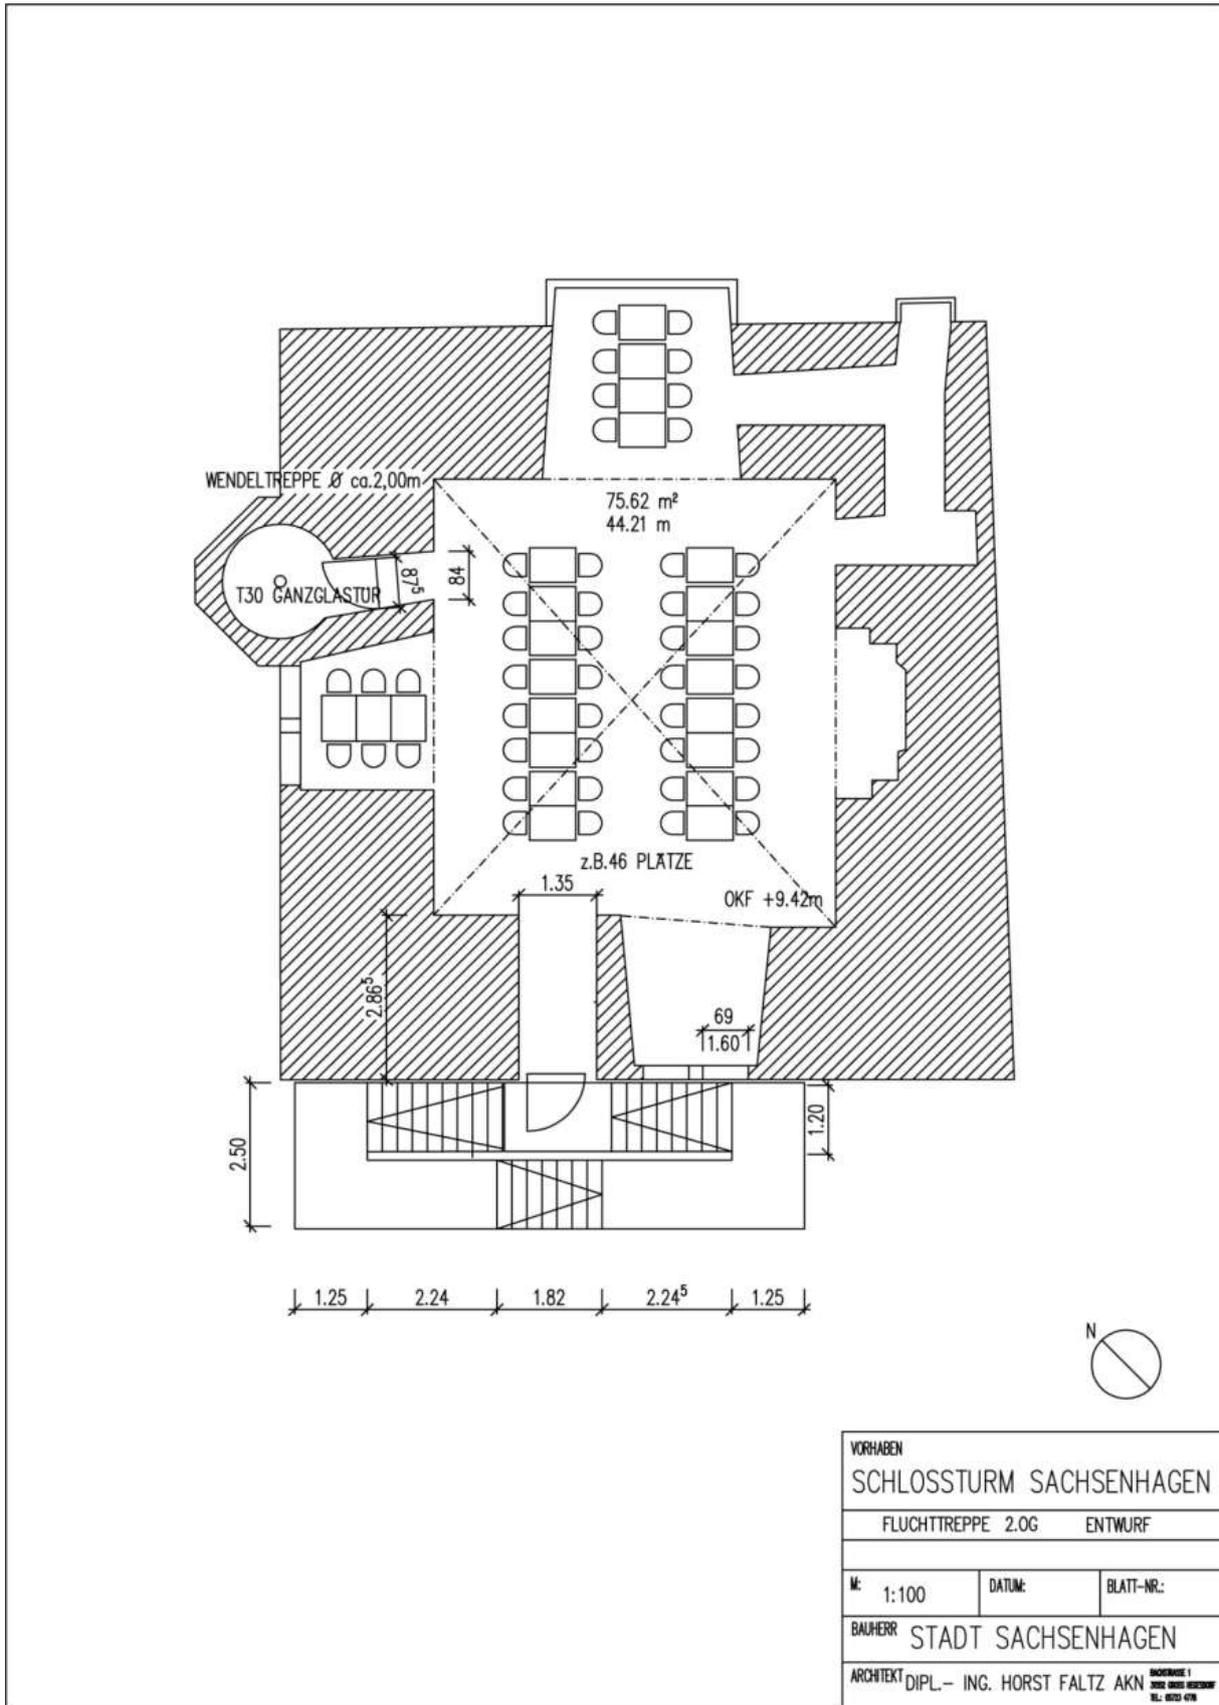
Grundriss 2. OG mit Bestuhlungsplan
